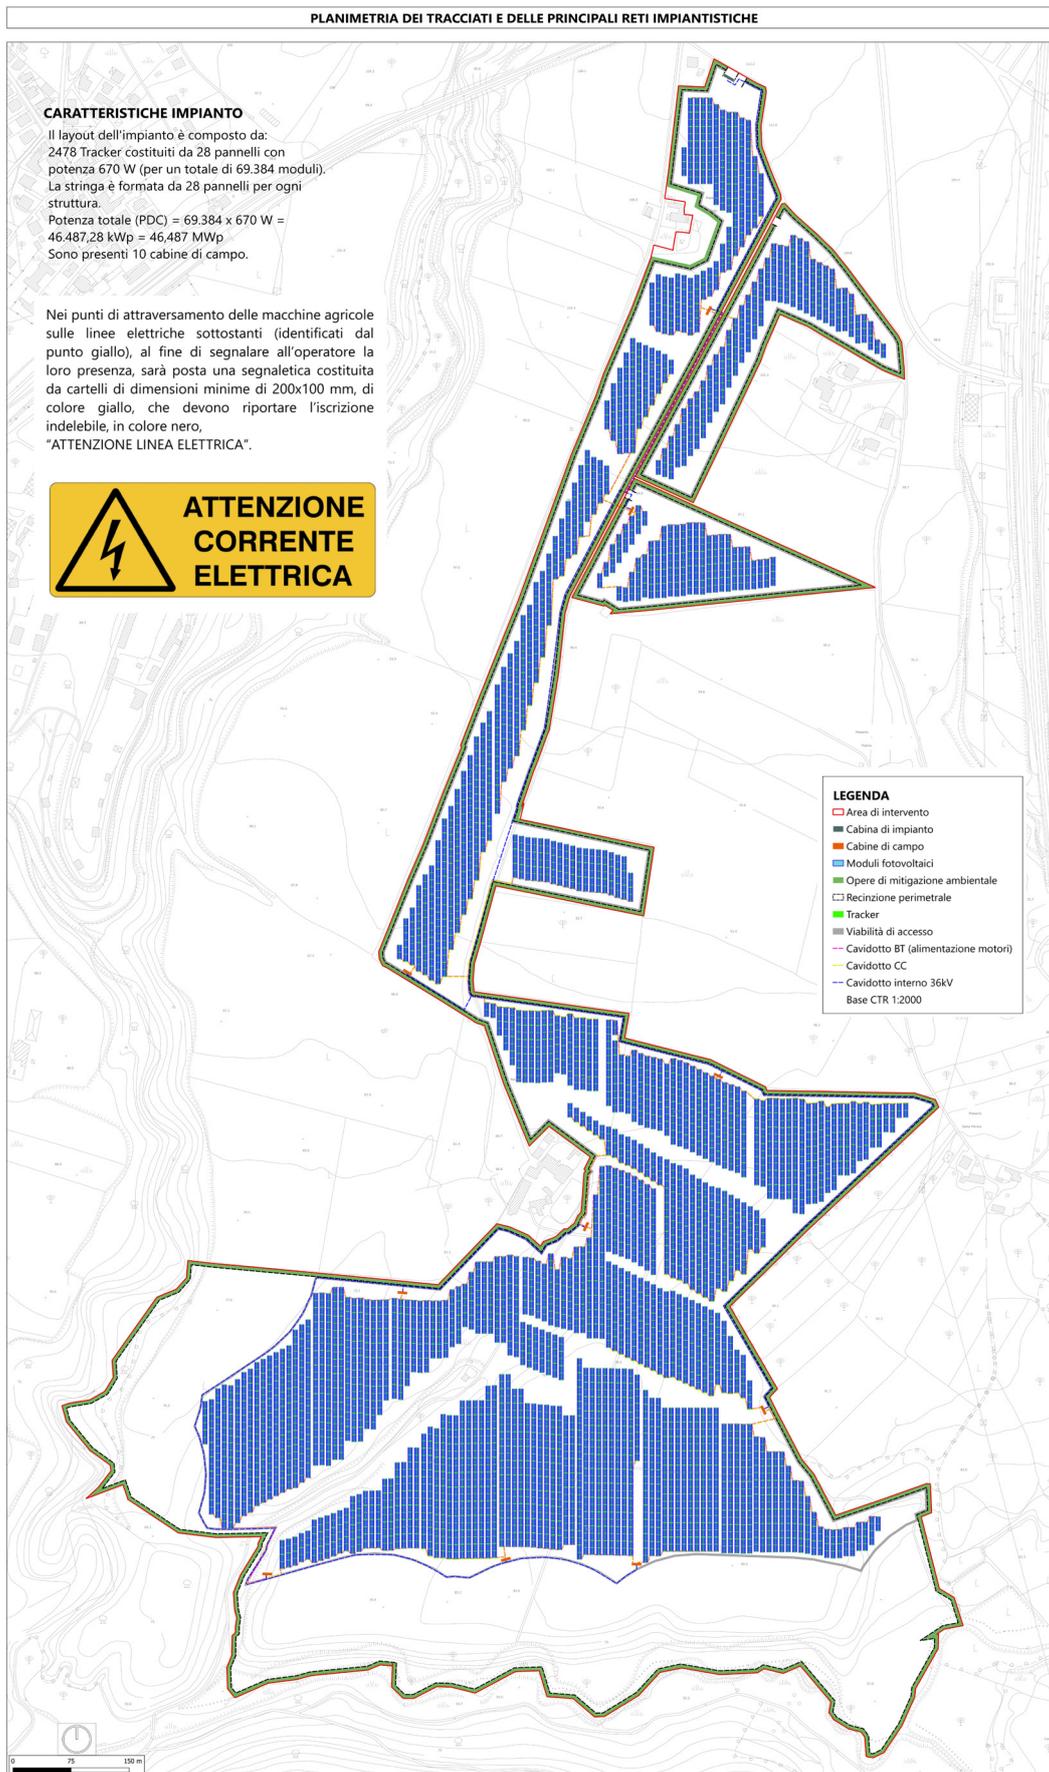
Planimetria dei tracciati e delle reti impiantistiche
